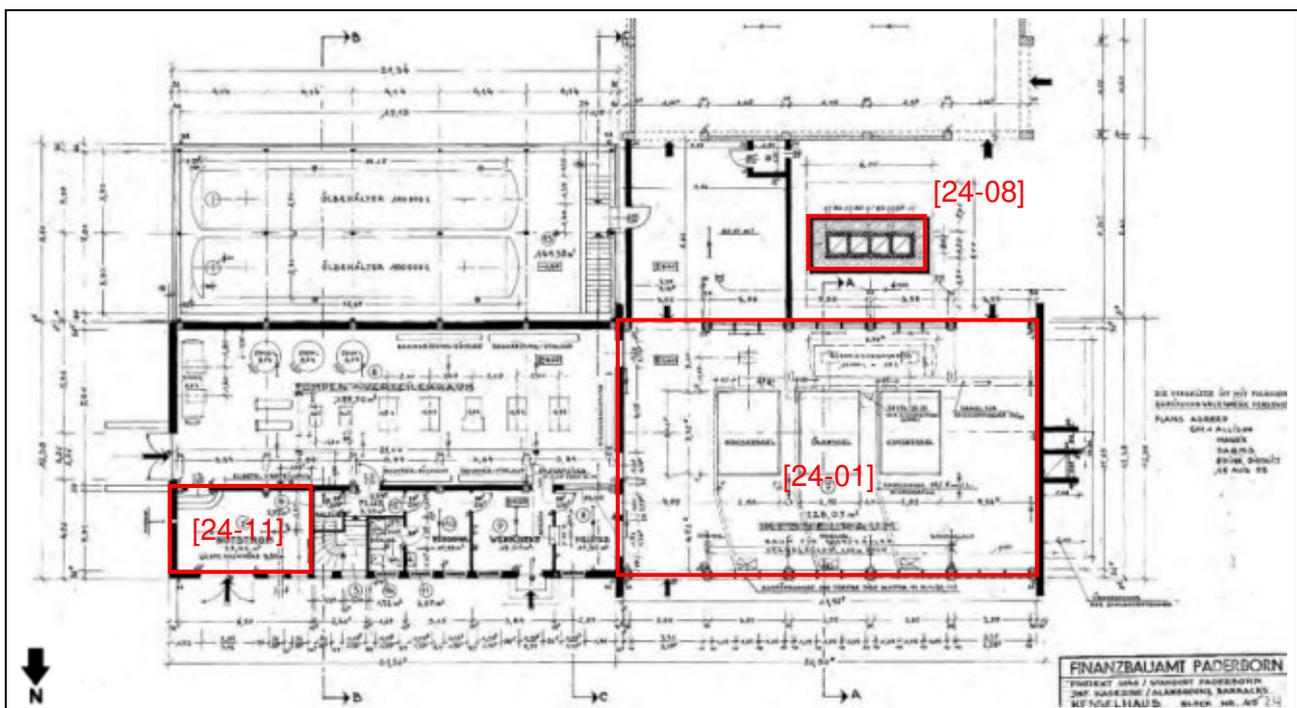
Heizzentrale (Grundriss/EG - 1957) (Quelle: BIMA Münster)
